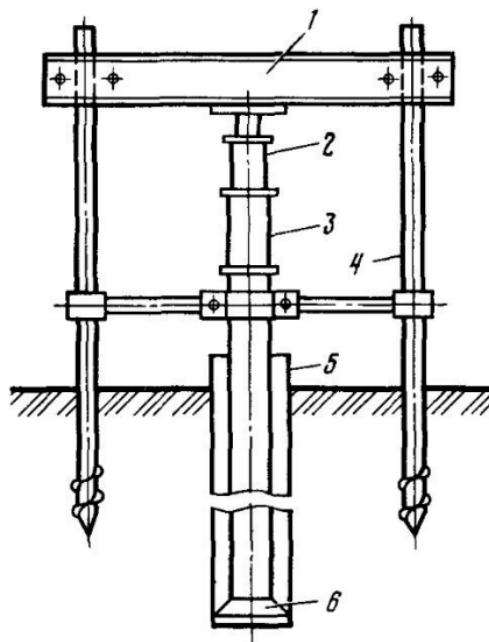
Схема установки для испытания грунтов пробной нагрузкой в скважине:
